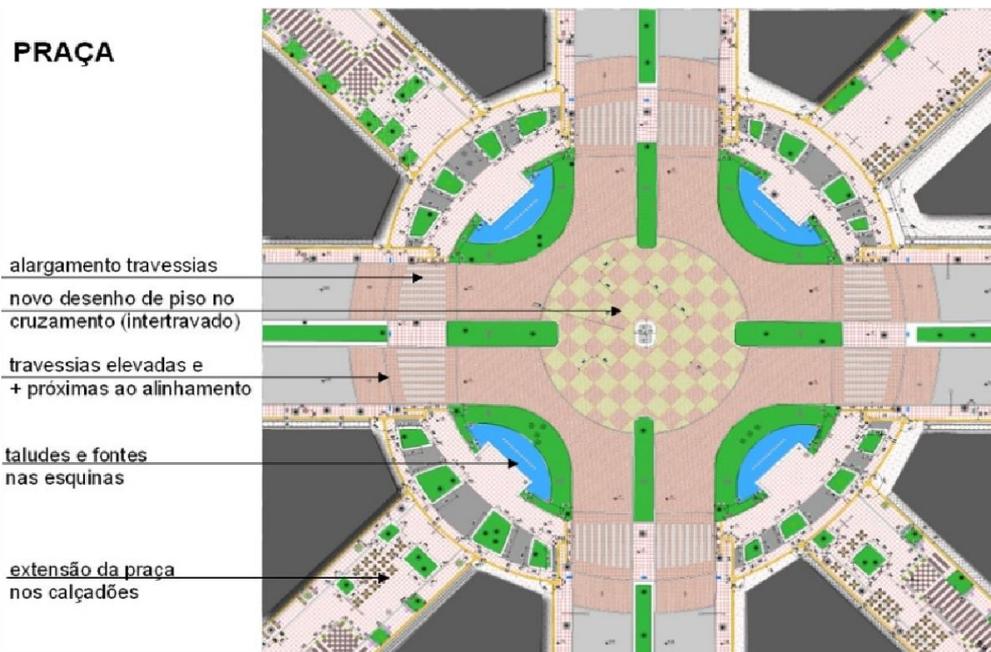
PLANTA DA INTERVENÇÃO NOS QUARTEIRÕES FECHADOS PARA IMPLANTAÇÃO DOS CALÇADÕES
